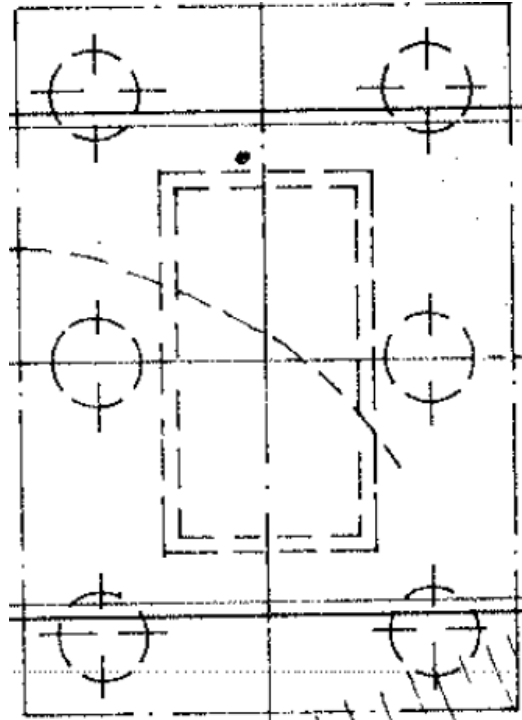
Pianta Pile a 6 pali (P1÷P3, P26 e P27)
